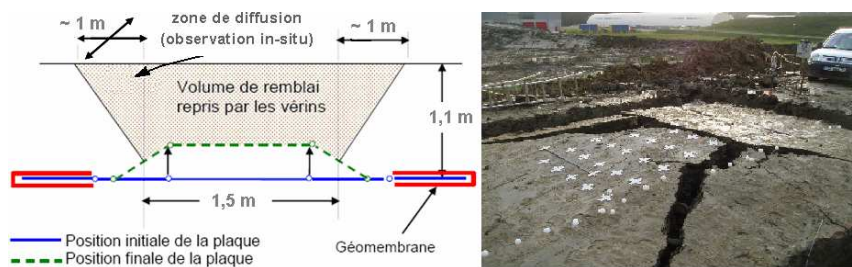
Schématisation de la poussée de la plaque in-situ.
